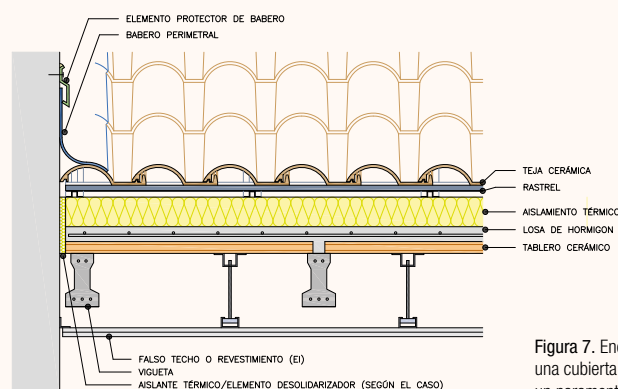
Encuentro de una cubierta QB13 con un paramento vertical.
